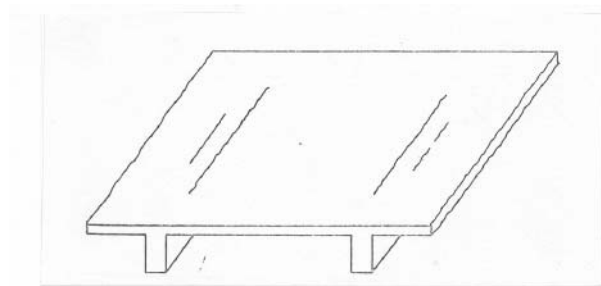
Fissuras na face superior de lajes devidas à ausência de armadura negativa
